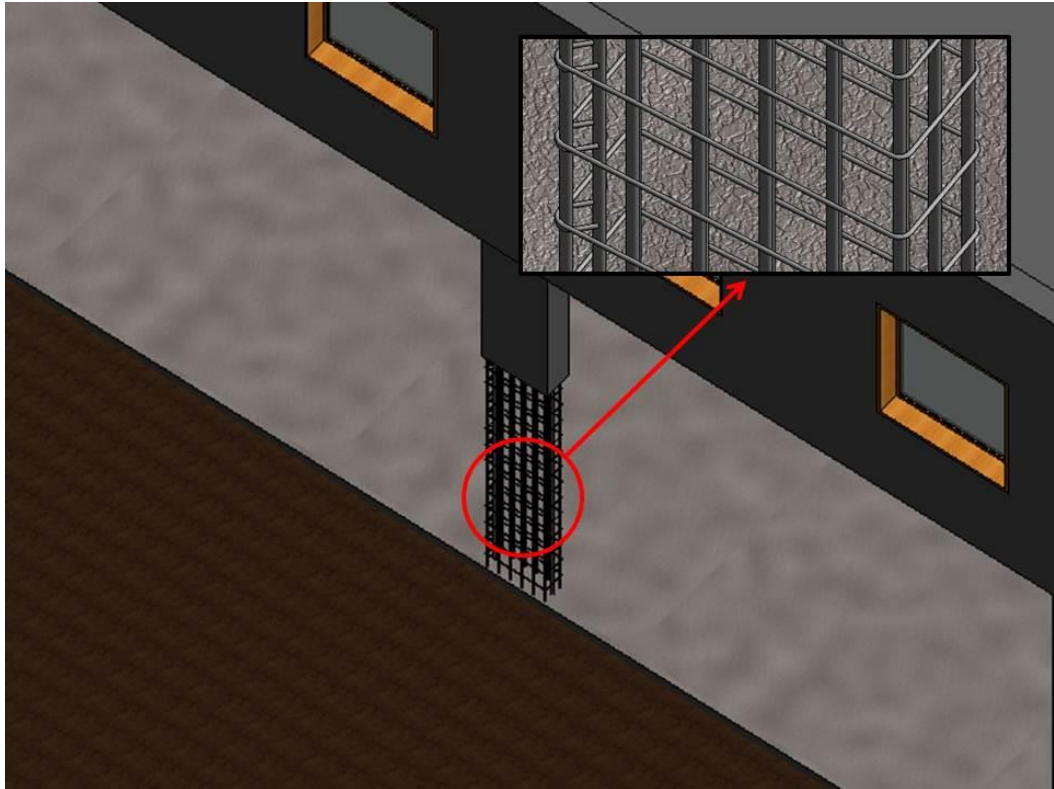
Pormenor da amarração das armaduras transversais de um pilar recorrendo à Autodesk Revit 2013 em vista 3D
